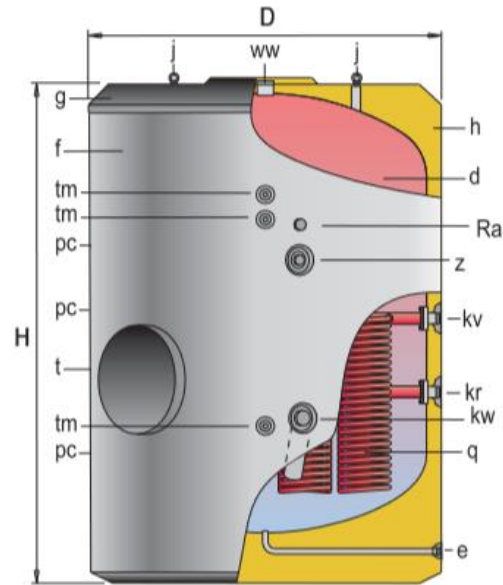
Interacumulador Lapesa MXV-3000-SSB
